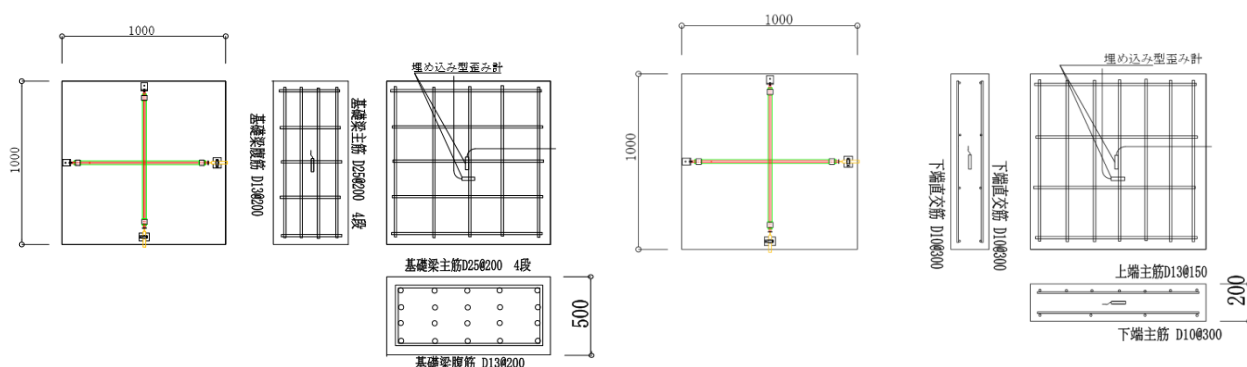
スラブ および基礎梁基本試験体形状・断面
